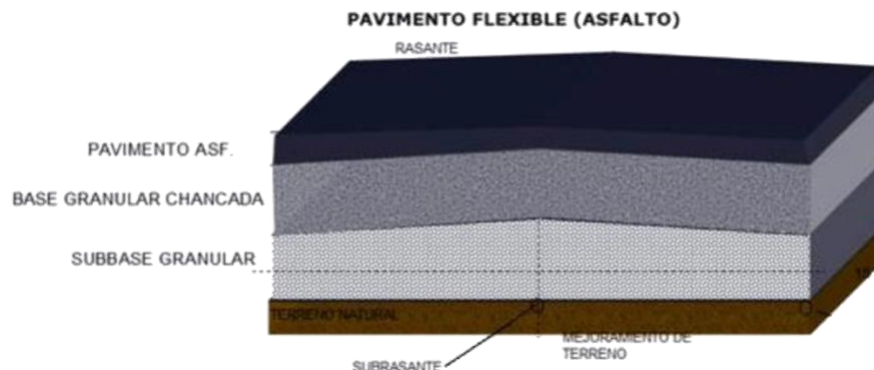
Esquema de composición de pavimentos flexibles [5].
